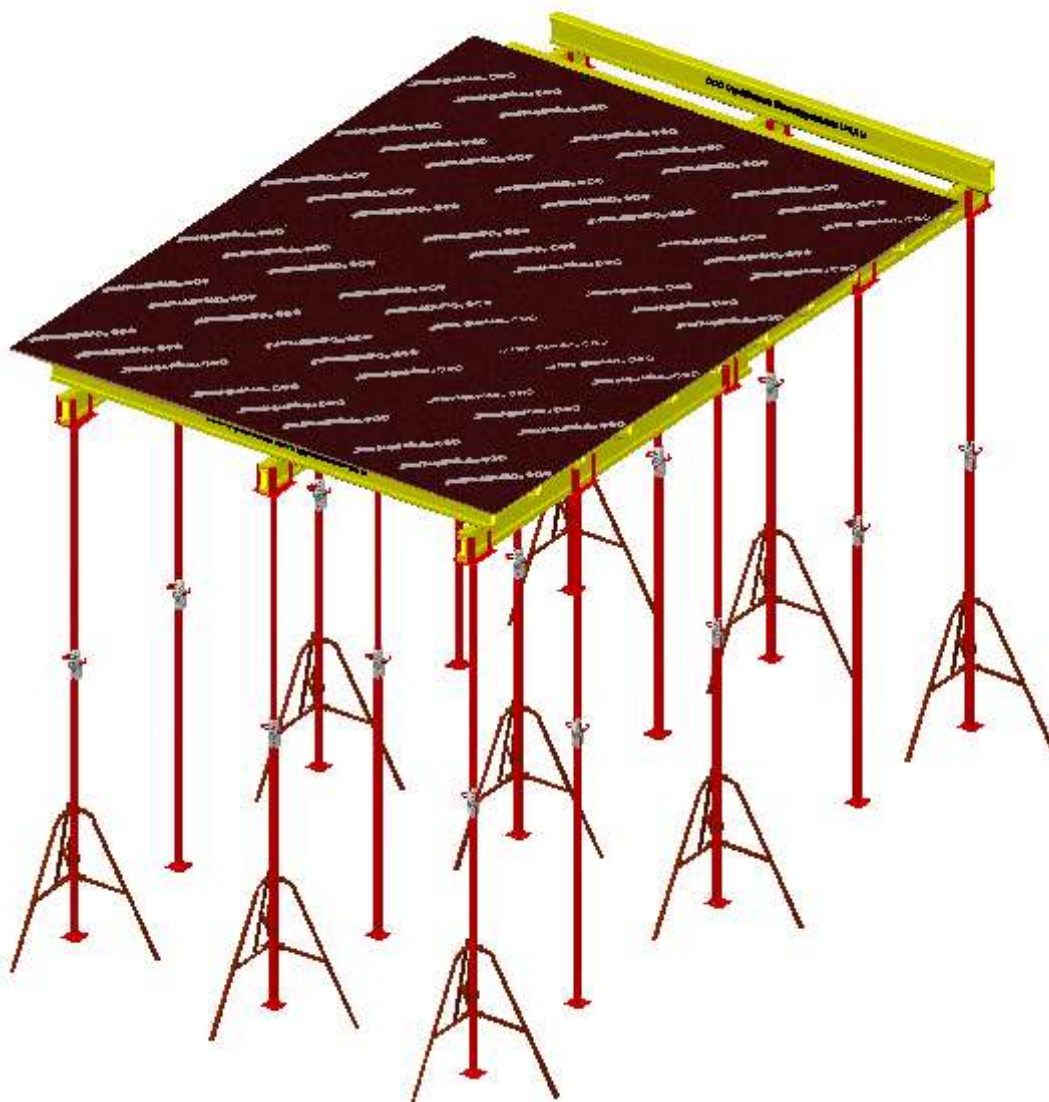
Общий вид опалубки перекрытий с использованием телескопических стоек.
